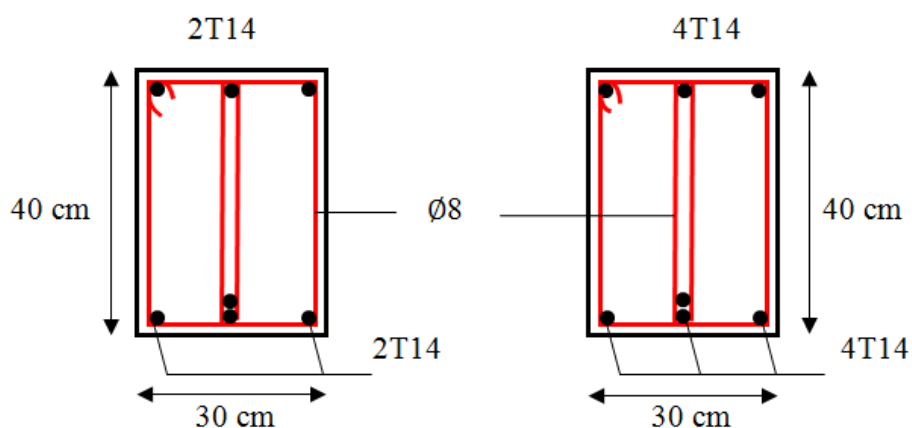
Ferrailage des poutres principales et secondaires.
